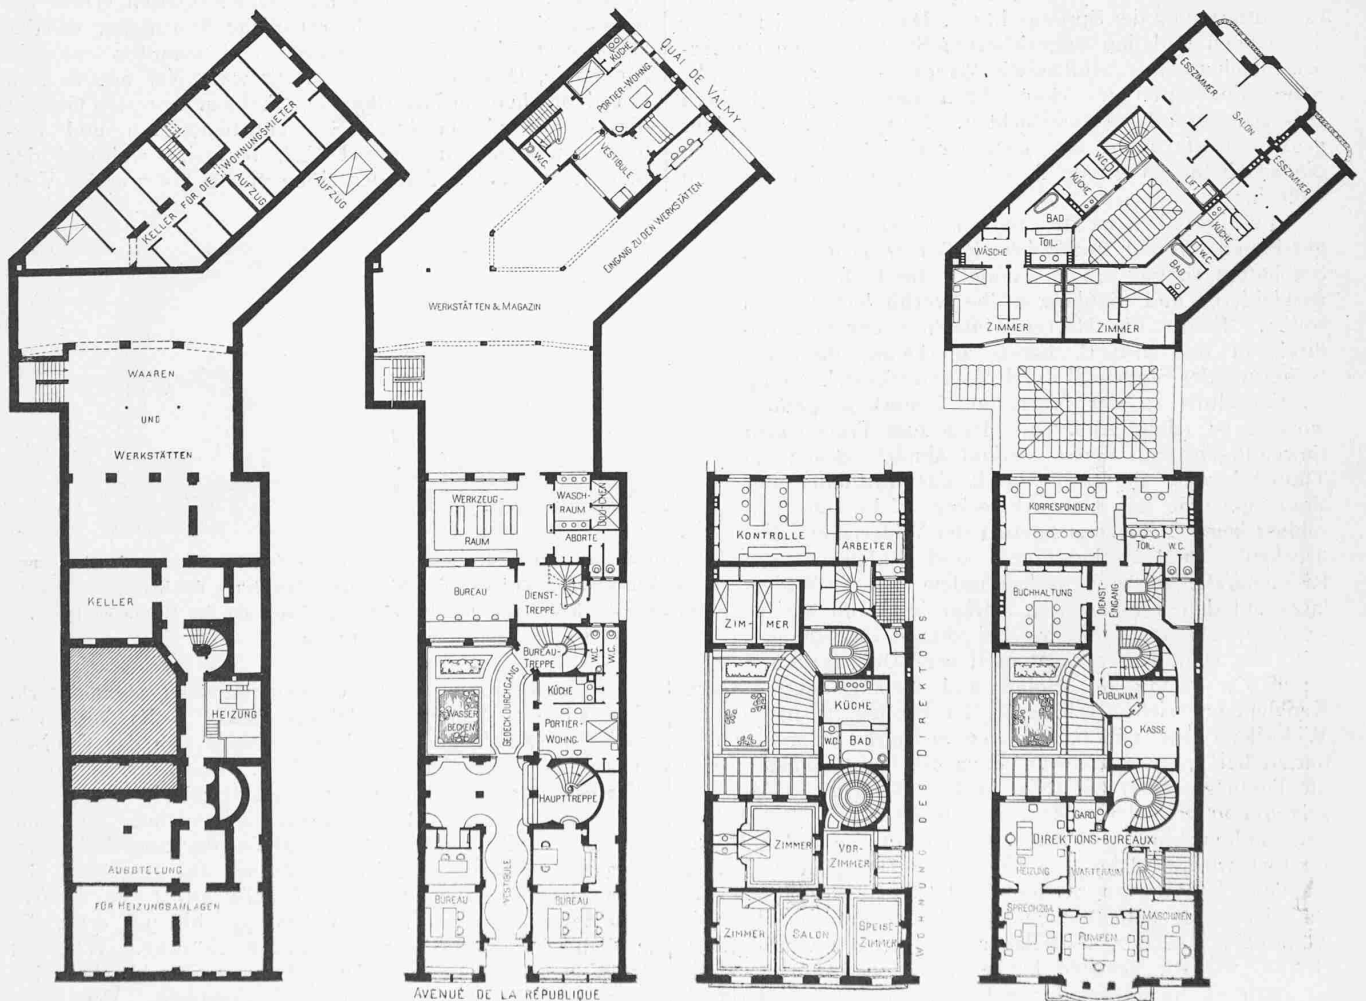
bis 4. Grundrisse vom Kellergeschoss, Erdgeschoss, Zwischengeschoss und ersten Stock des Geschäftshauses der Firma Gebrüder Sulzer in Paris. — Masstab 1 : 400.
